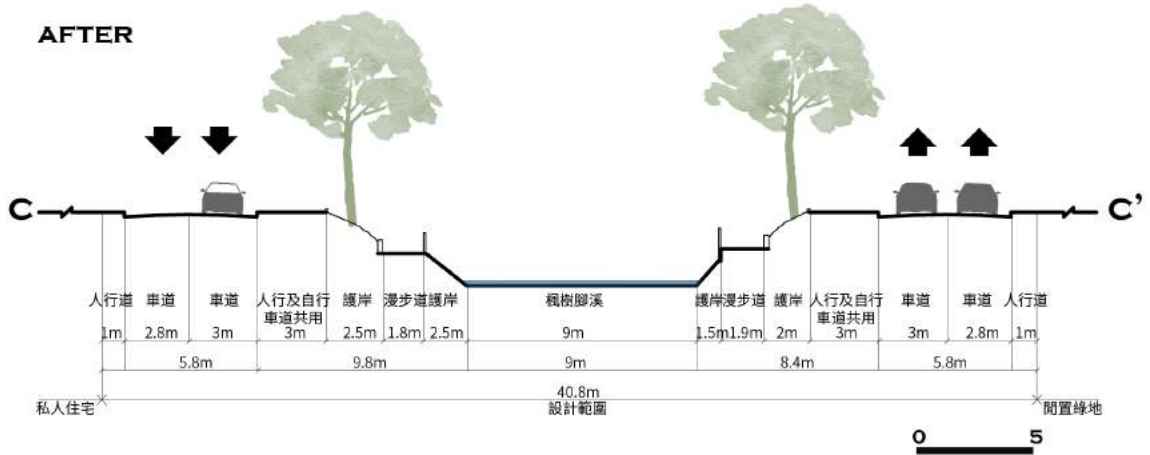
永春東二路、永春東三路現況及改善構想剖面示意圖
